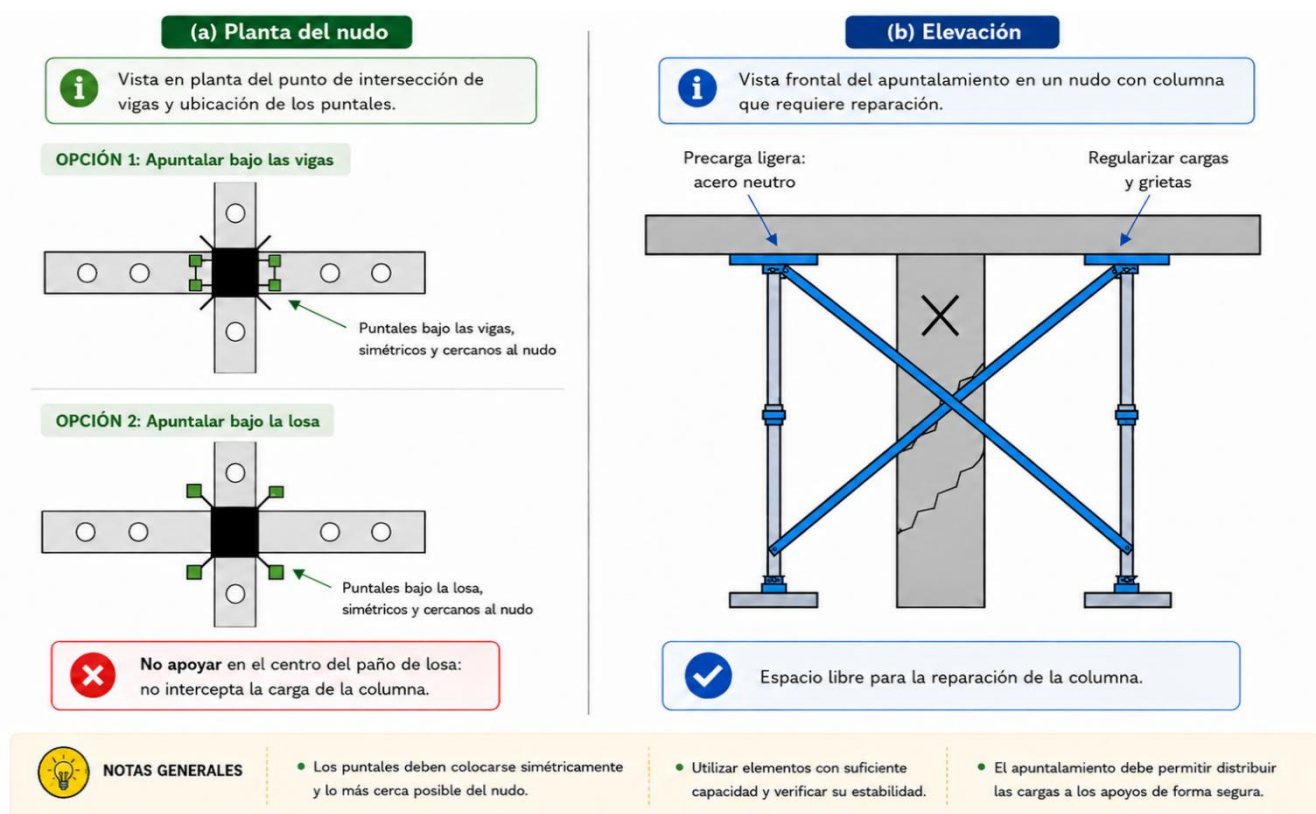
Apuntalamiento simétrico de la losa y de las vigas que concurren a una columna dañada, dentro de su área tributaria. Fuente: elaboración propia según SAIA (2026) y FEMA (2013).
